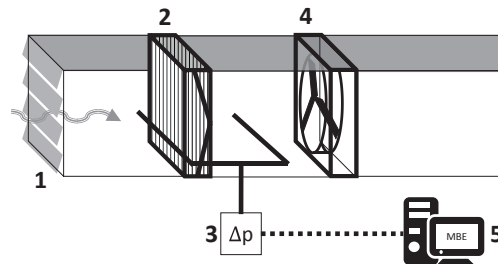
Luftfilterüberwachung einer Lüftungsanlage
